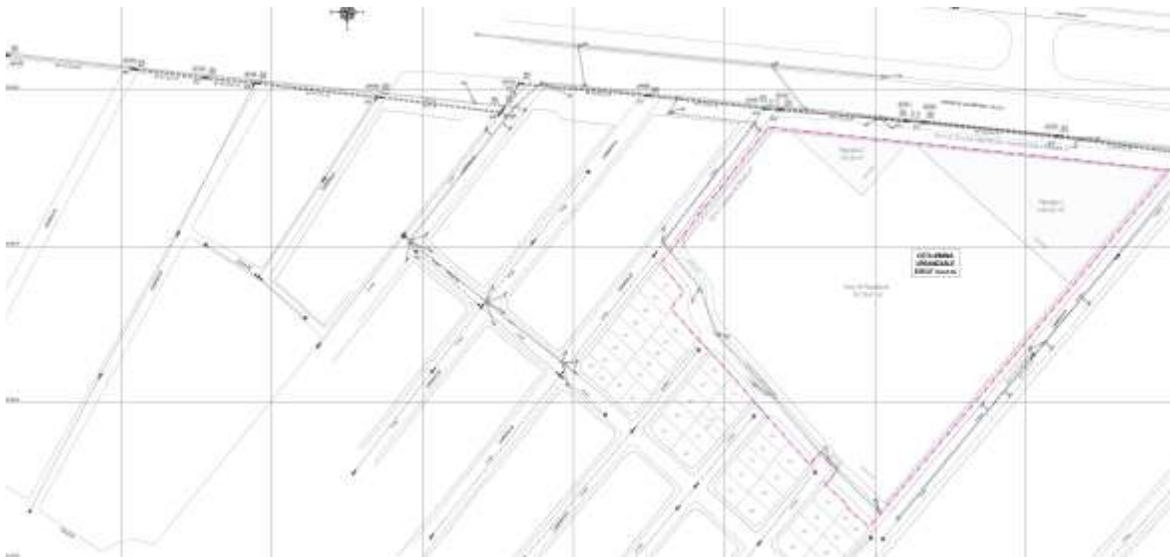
Red de Alcantarillado Sanitario, Plan Parcial Cartón Colombia
